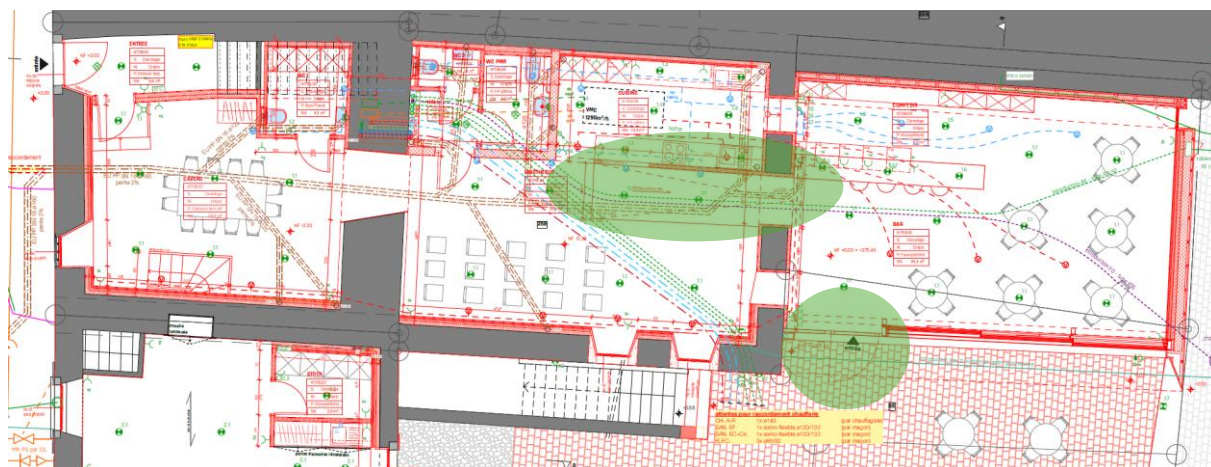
Extrait plan 51-50-2-F Rez 29.01.2025 - : accès mobilité réduite possible
